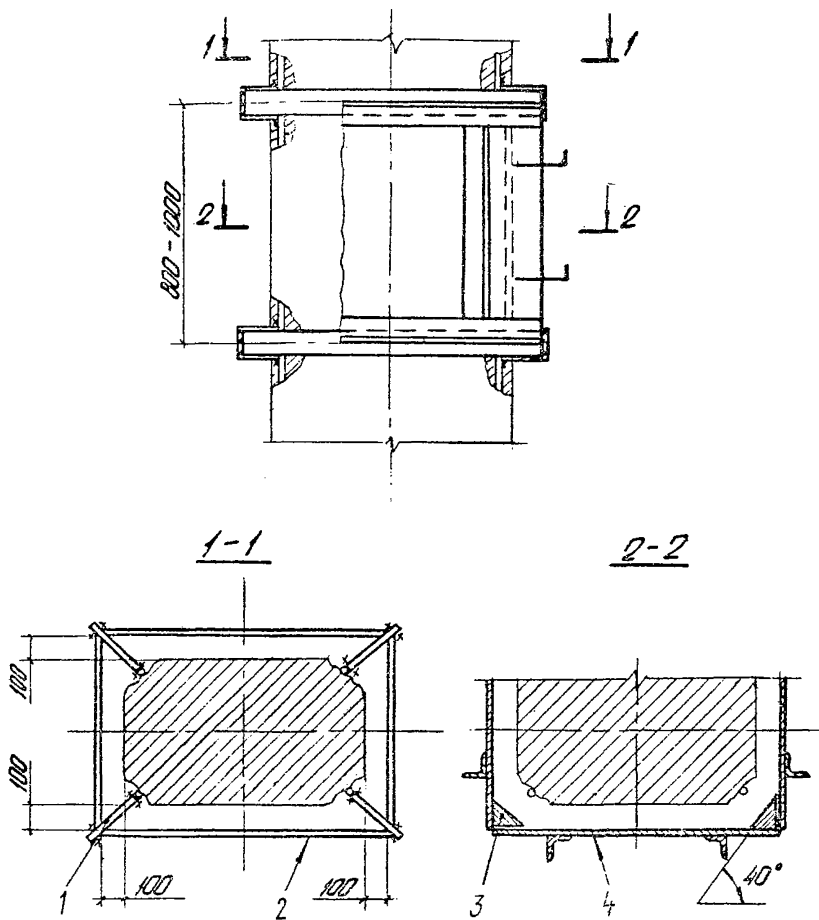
Схема крепления щитов опалубки к обоям:
